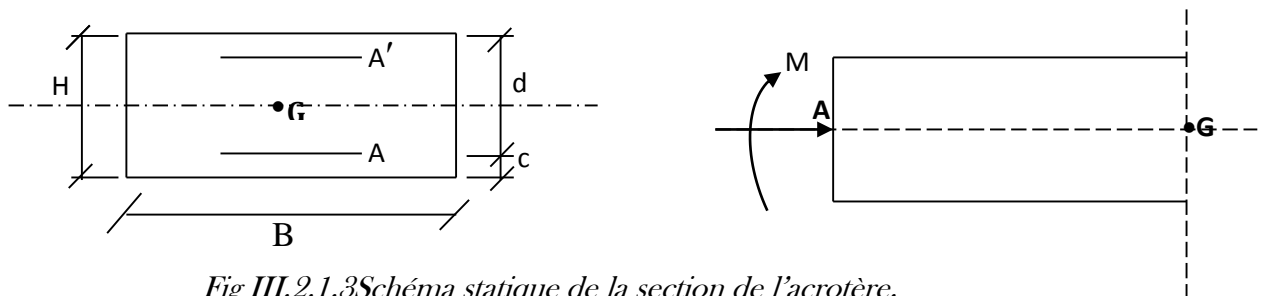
Schéma statique de la section de l'acrotère.
